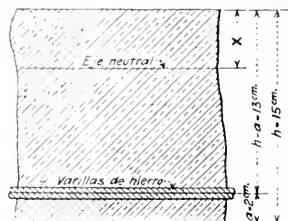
SECCIÓN LONGITUDINAL DEL HORMIGÓN
